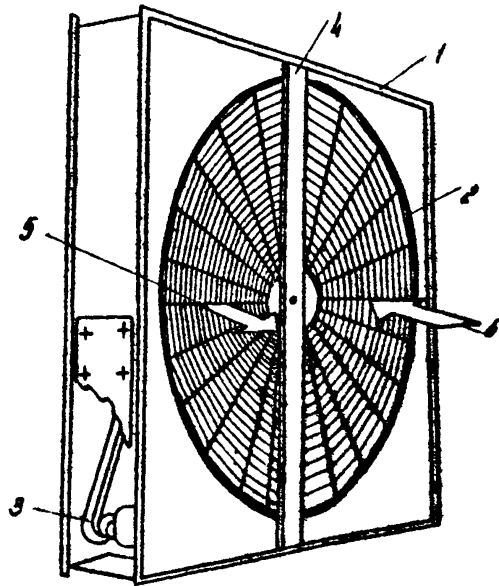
Схема устройства и работы вращающегося регенератора: 1- корпус; 2- теплоаккумулирующая вращающаяся насадка; 3- электродагма с приводом; 4- радиальное уплотнение; 5- удаляемый из помещения воздух; 6- поступающий наружный воздух.
